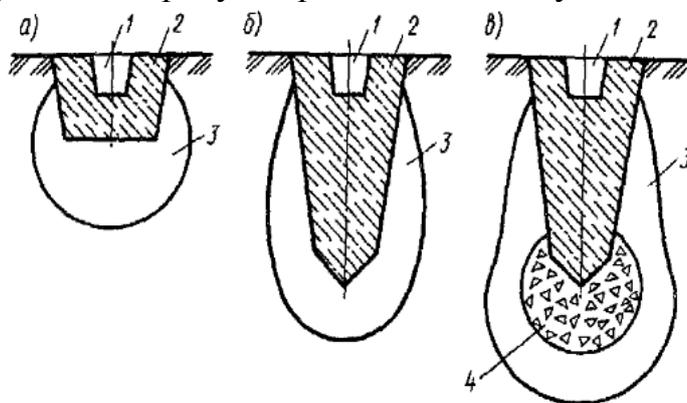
Схемы устройства методом вытрамбовывания котлованов фундаментов с плоской подошвой (а), с заостренной подошвой обычного типа (б) и с уширенным основанием (в): 1 — стакан для установки колонны; 2 — фундамент; 3 — зона уплотнения; 4 — втрамбованный жесткий грунтовой материал
